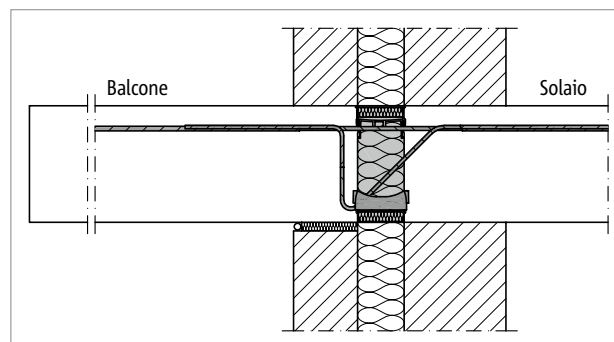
Schöck Isokorb® T tipo KL: raccordo con muratura bistrato con interposto isolamento
